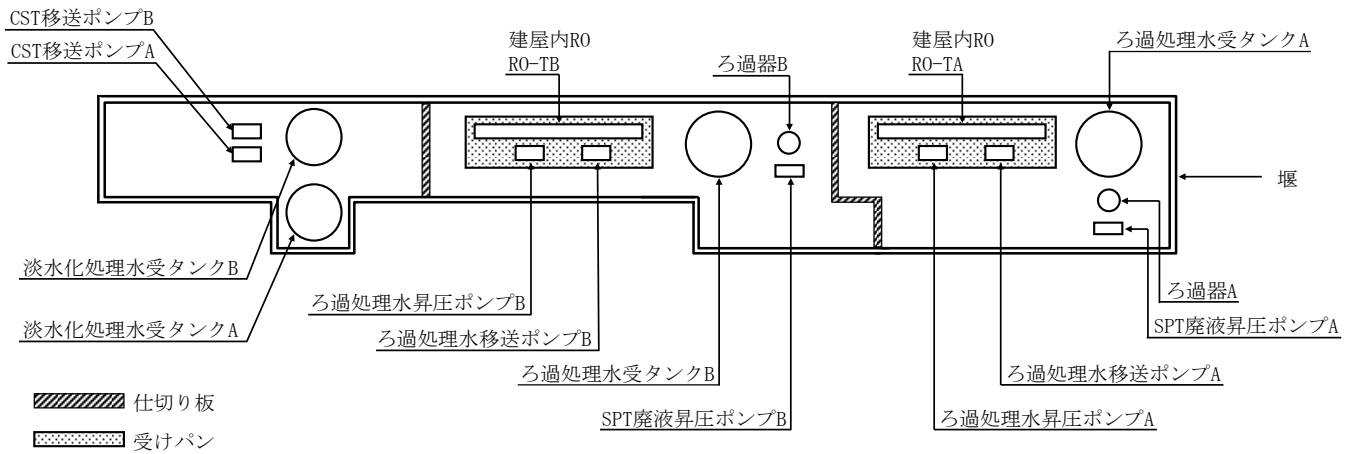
建屋内 RO 循環設備の漏えい拡大防止 堰配置図
